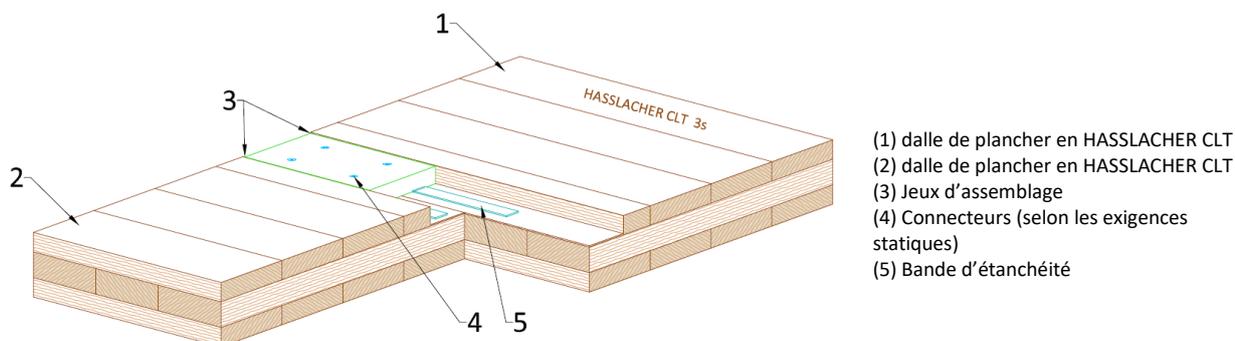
Assemblage des panneaux HASSLACHER CLT par fausse languette
